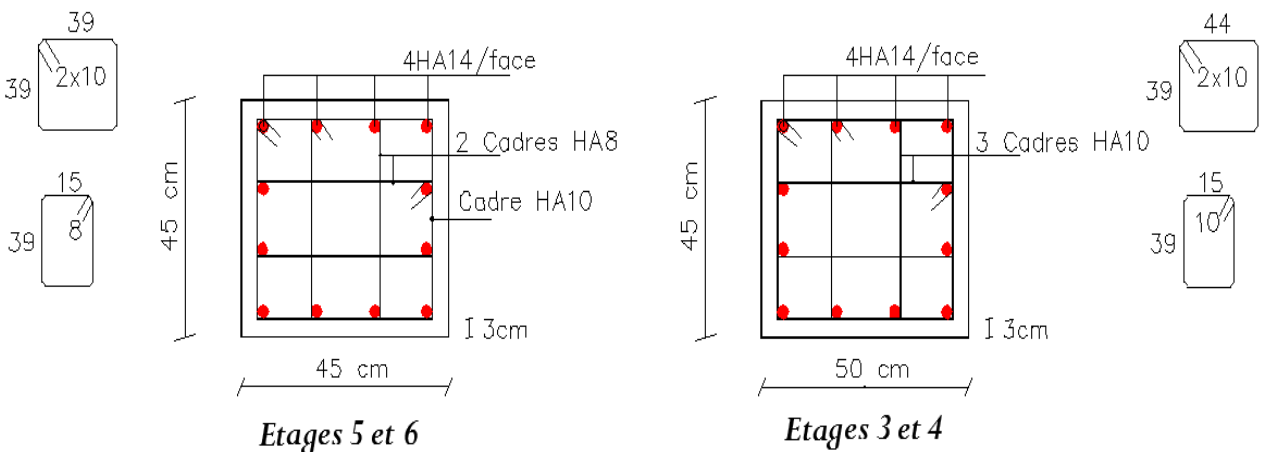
Schéma de ferrailage des poteaux d'étages 3 à 6
